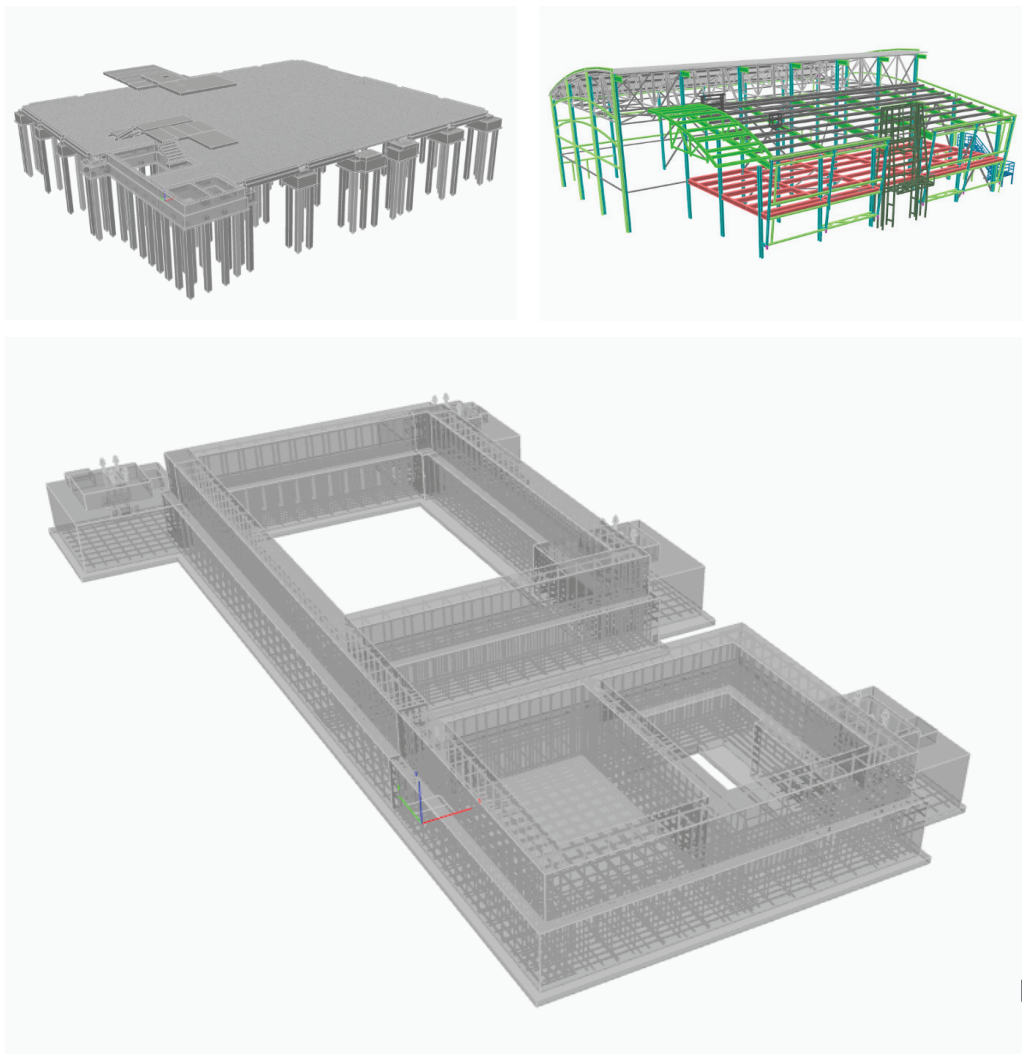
Проектирование железобетонных и металлических конструкций ФОКа в программе nanoCAD BIM Конструкции
